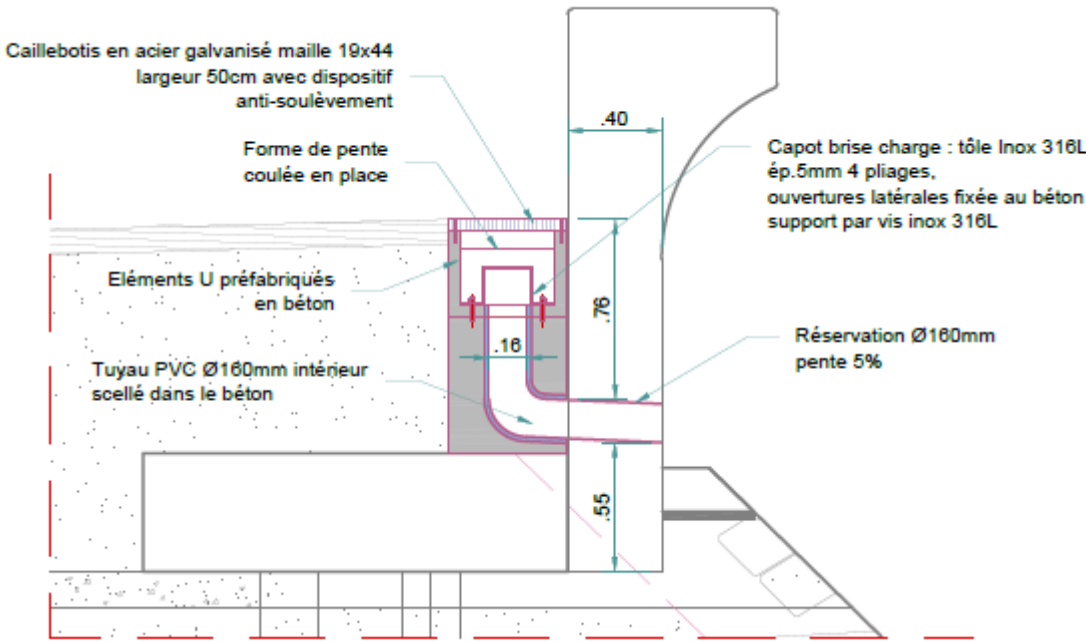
Coupe de principe sur l'évacuation des eaux à travers le parapet
